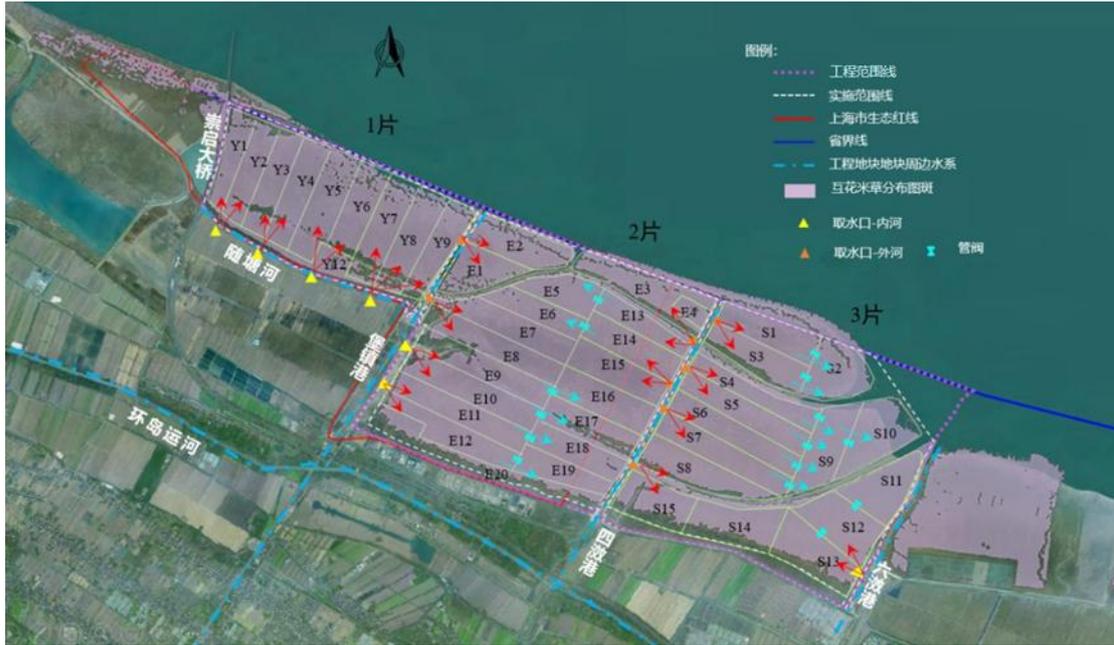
淹水期水泵临时取水口、管阀平面布置图
